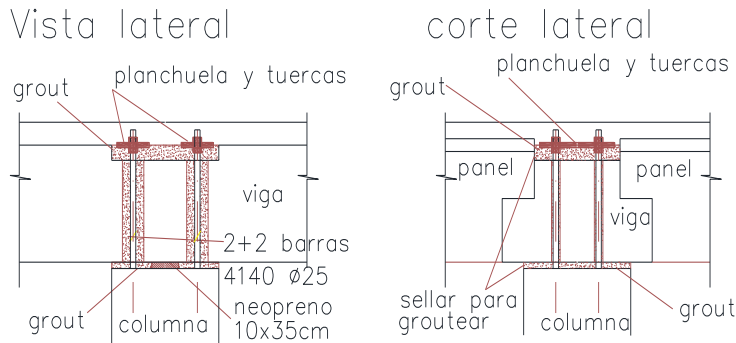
Detalle de unión columna y viga mediante pasadores
